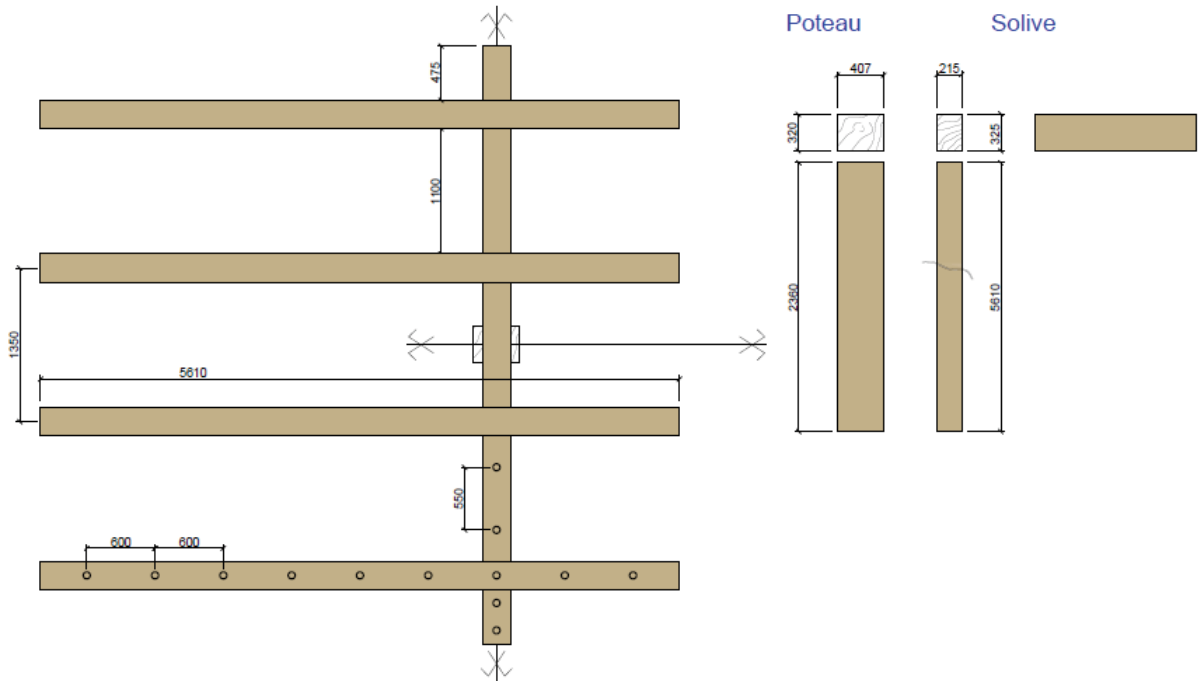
Détail de la structure bois de la cellule d'essai pour l'essai 3 (poteau/poutres LC)
